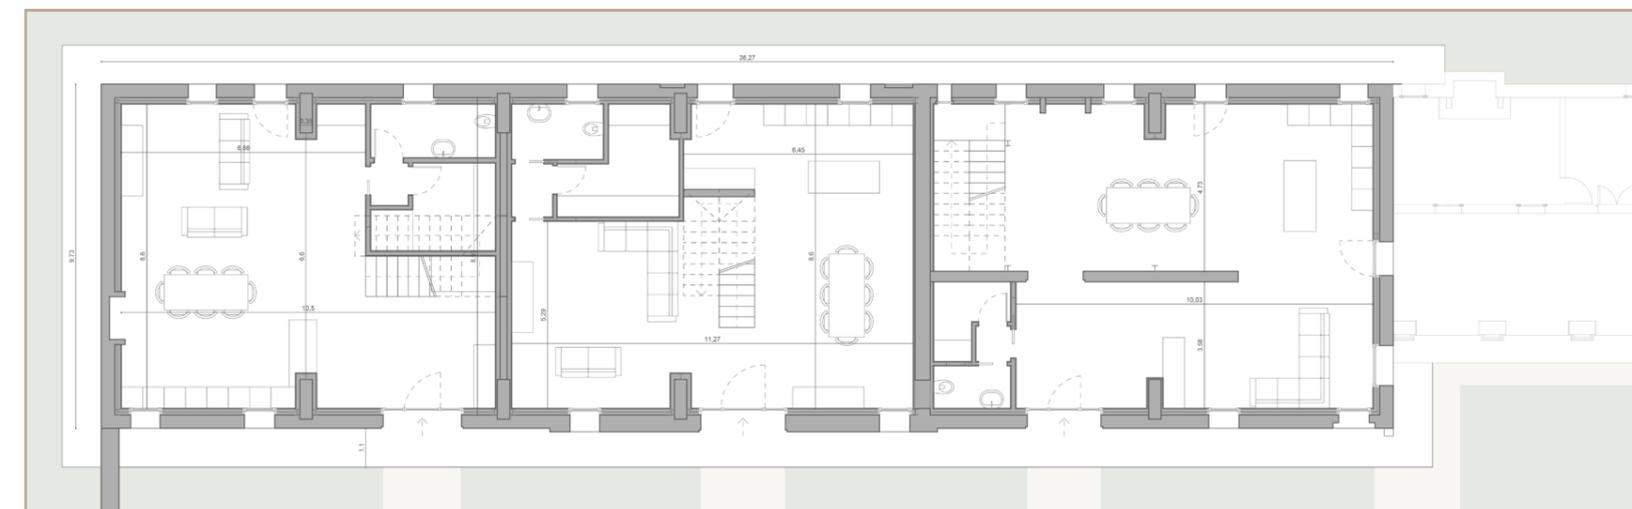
Pianta del piano terra, rilievo geometrico, scala 1:200
